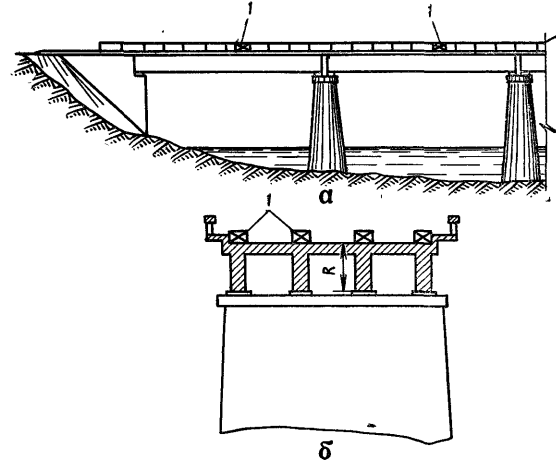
Подрывание пролетных строений железобетонного балочного моста зарядами на проезжей части:
